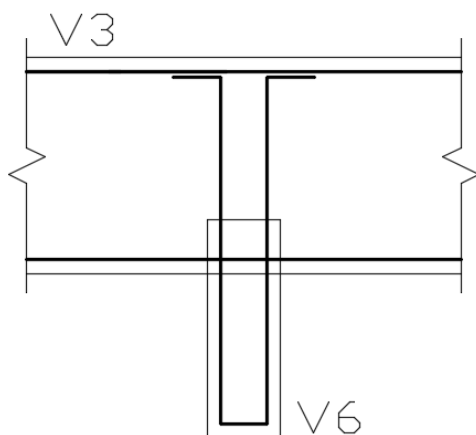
Detalhamento das armaduras de suspensão no CAD/TQS
